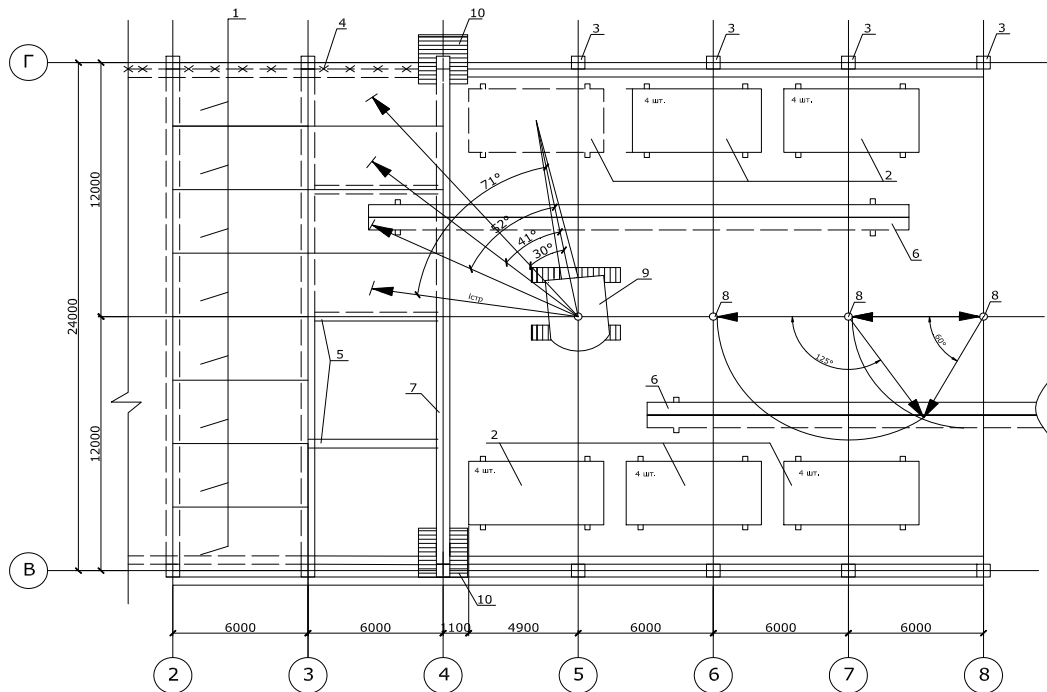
Технологическая схема монтажа конструкций покрытия и плит покрытия:
